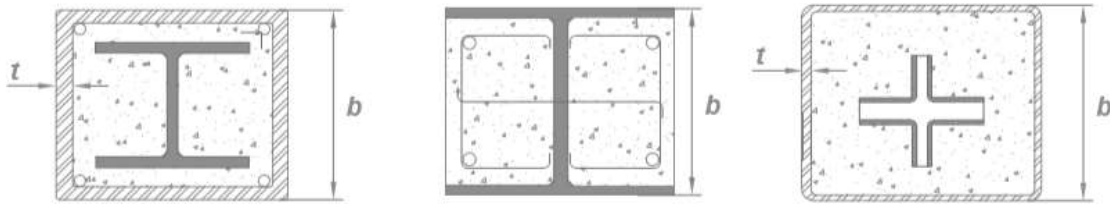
Columnas compuestas acero - concreto perfiles de acero embebidos en concreto reforzado
